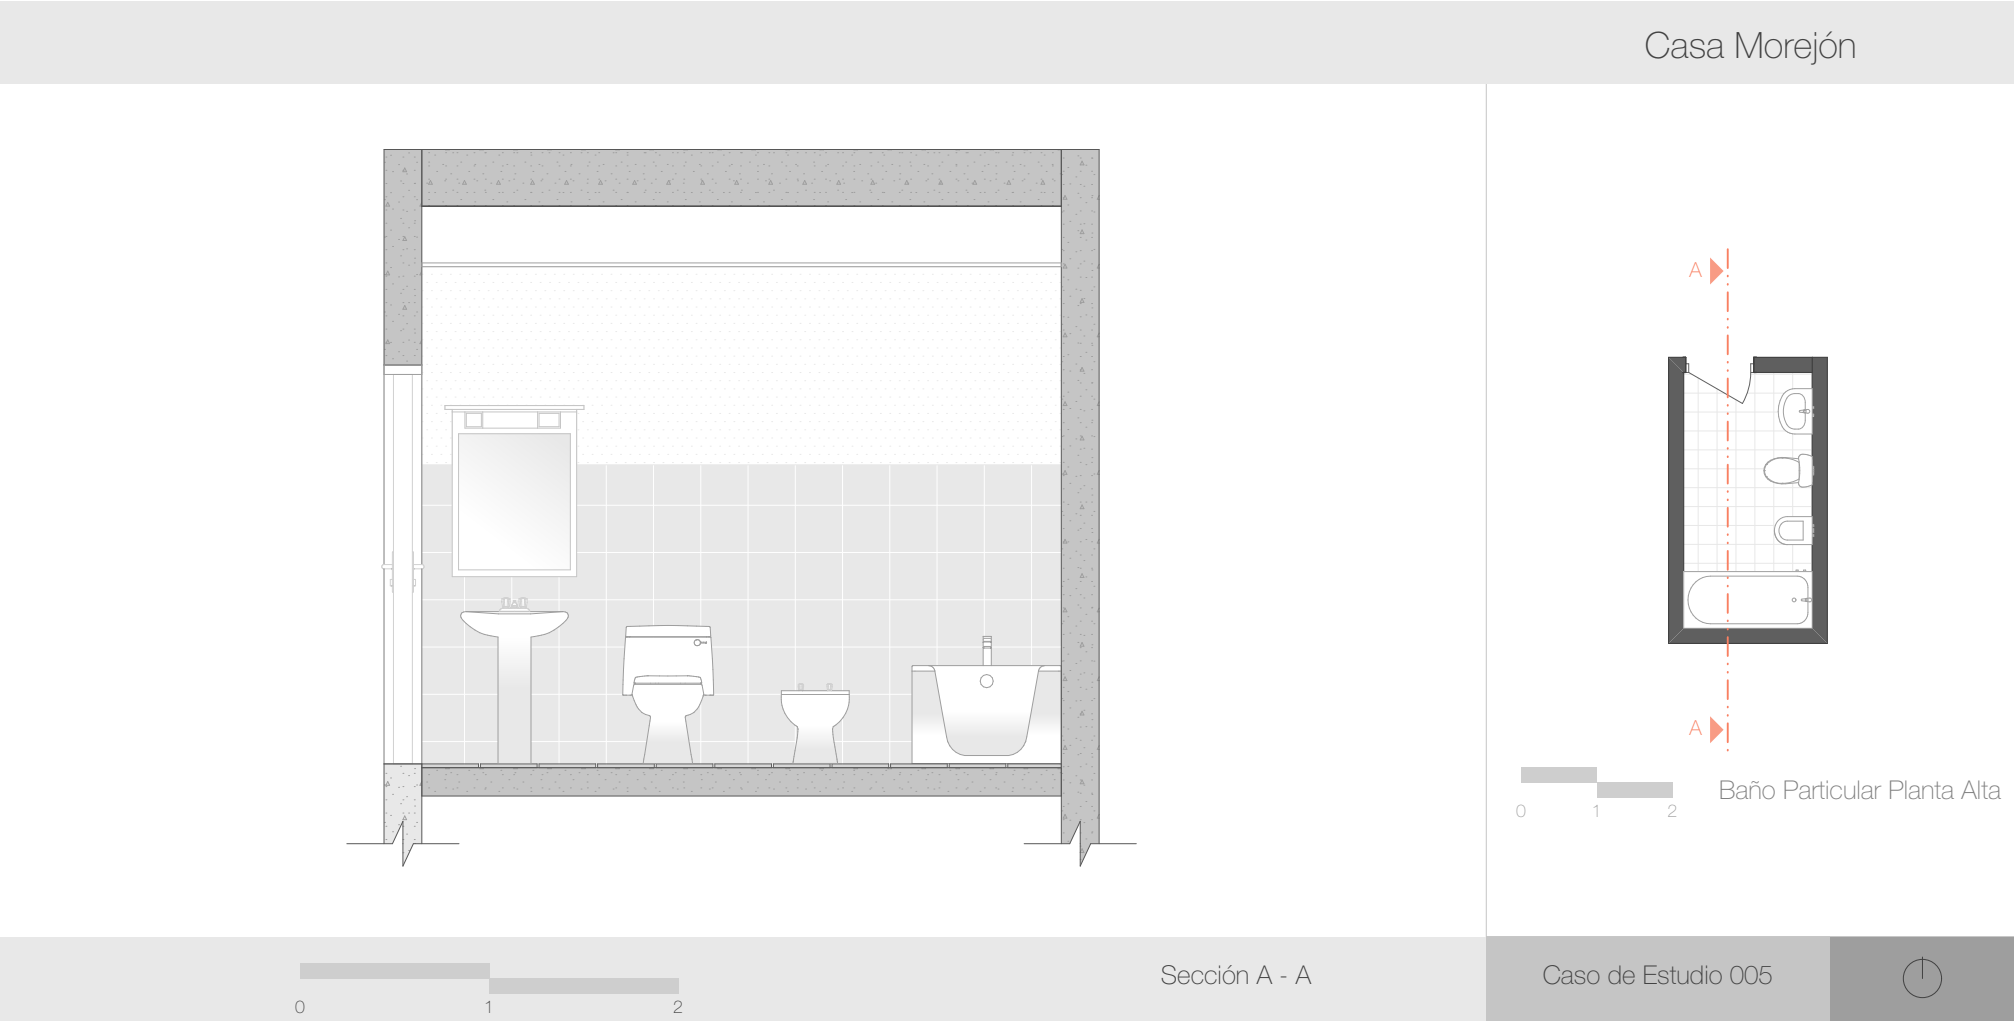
Mobiliario sanitario empleado en la vivienda Morejón Planta Alta
